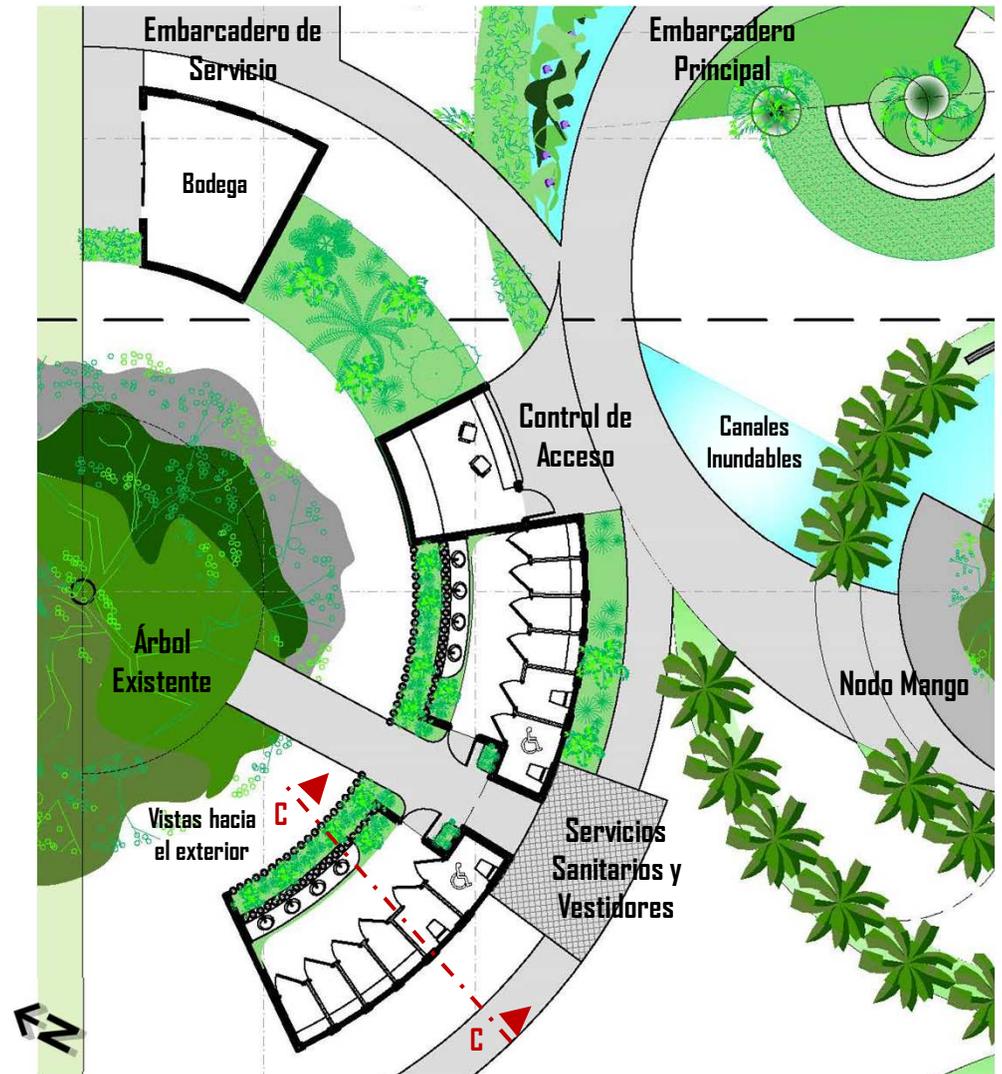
Planta de distribución arquitectónica. Control de Acceso
